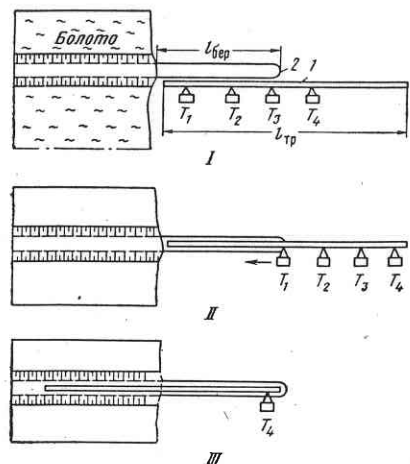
Схема укладки трубопровода сплавом (вариант 1)
